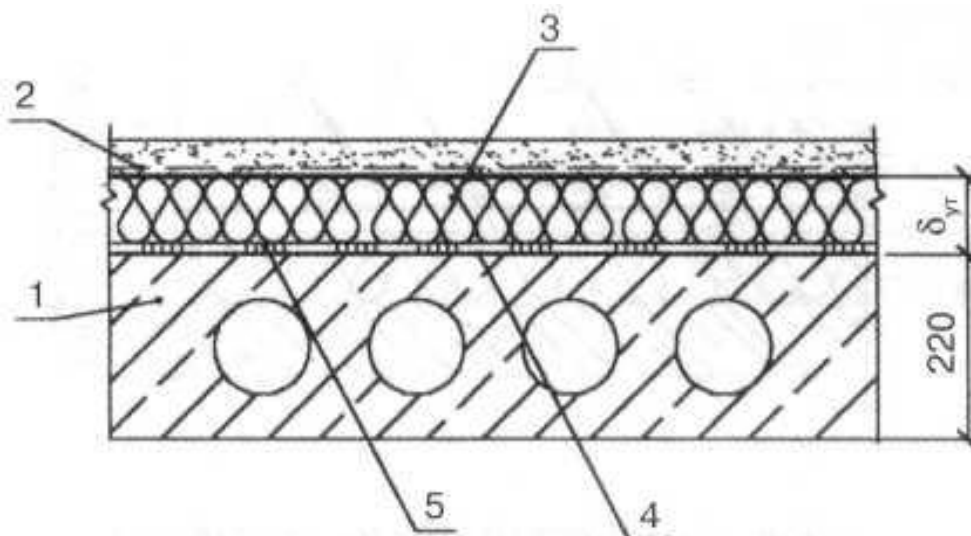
Схема утепления пола первого этажа над холодным подвалом
